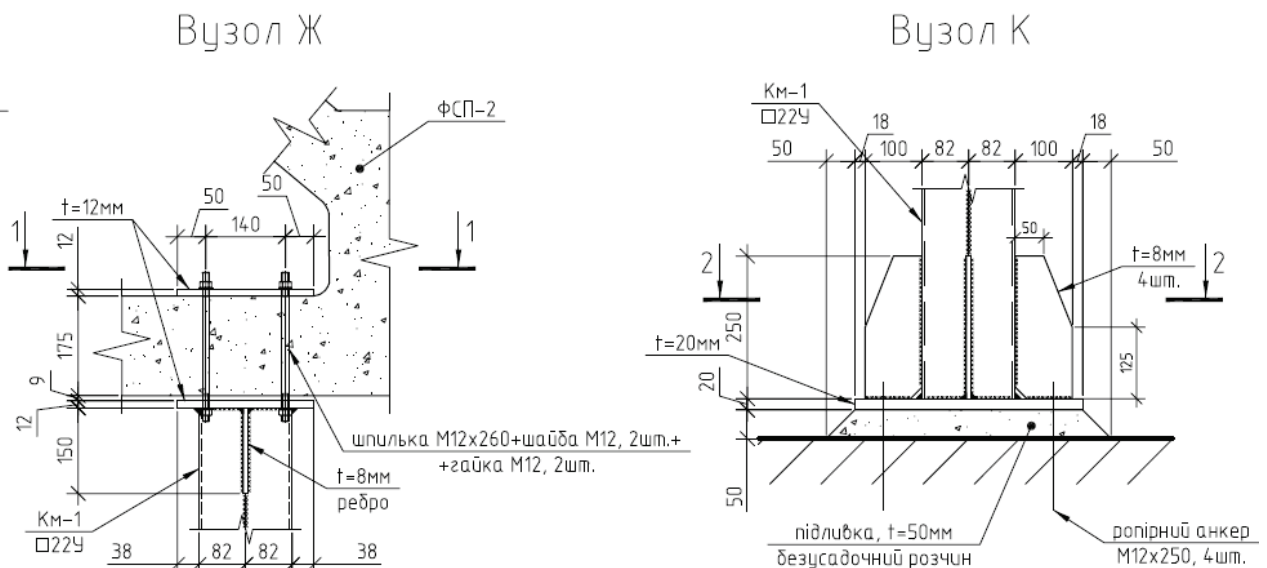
Опорні вузли колон підсилення по фермі ФСП-2
